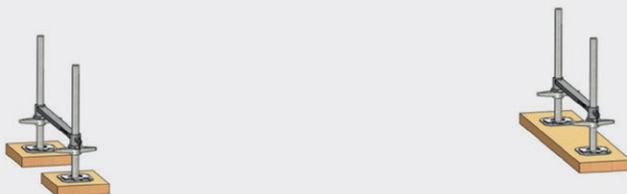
Винтовые опоры с опорными поперечинами или поперечинами для настила
